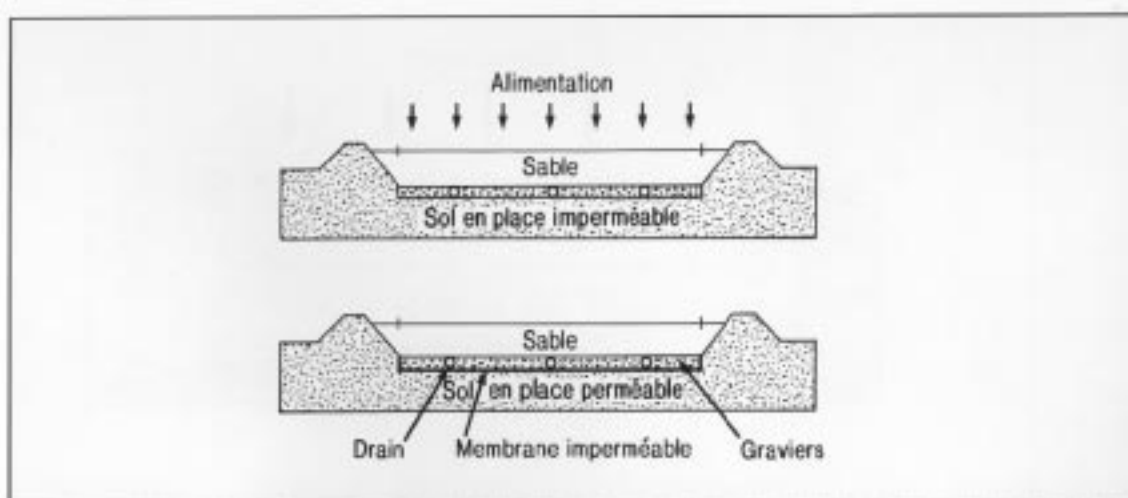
Systèmes drainés sur sol en place imperméable (haut) ou avec un massif drainant étanché par une membrane imperméable.
